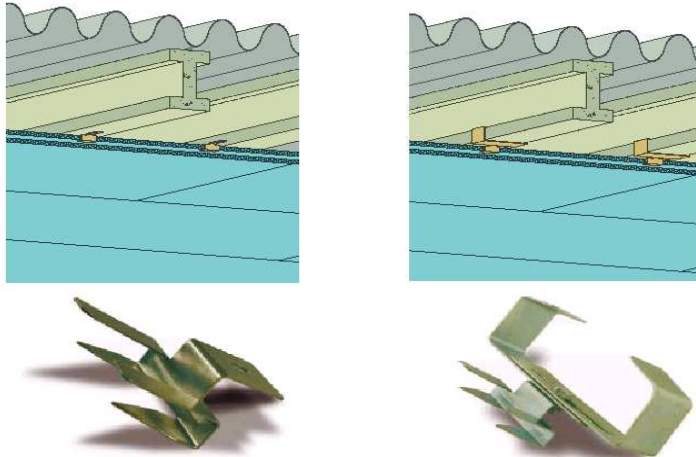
y 5.1.30. Sujeción de planchas de XPS bajo correas de cubierta¹.
